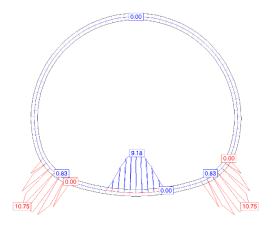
Secção TV.1. Armaduras de cálculo de flexão (cm²/m)
